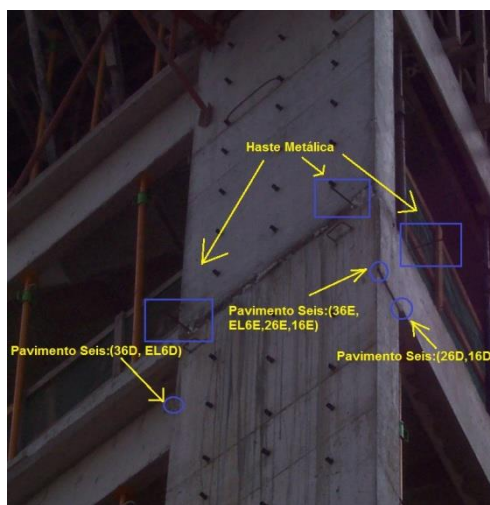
Materialização com hastes metálicas no entorno do pilar 8 e de cada pavimento da edificação.
